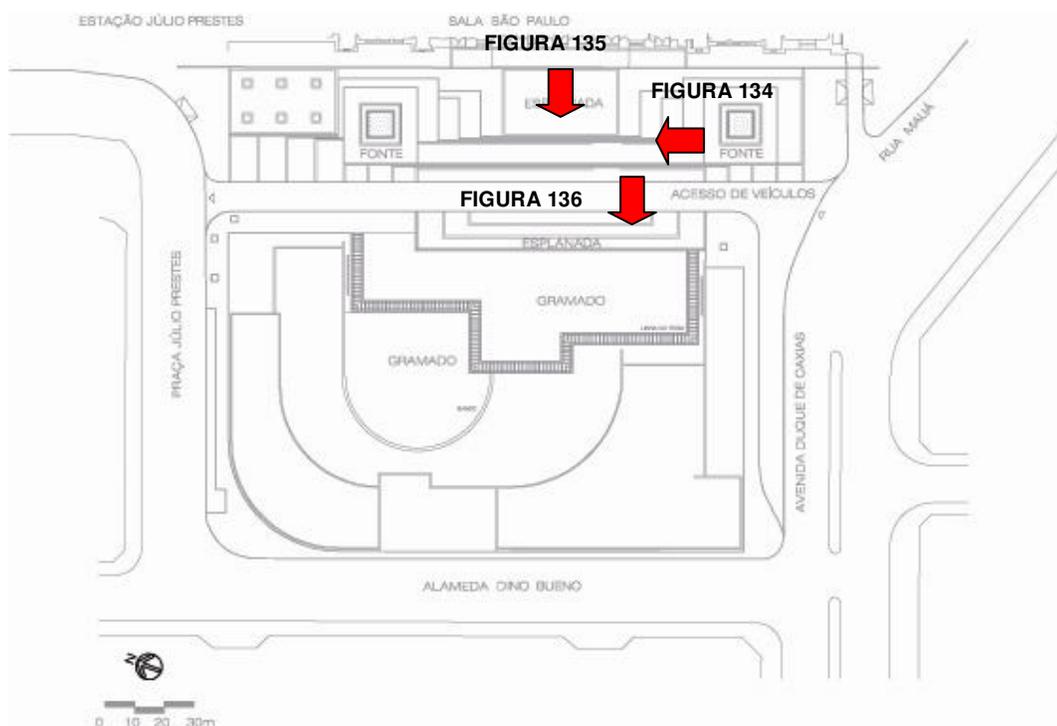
Planta da Praça Júlio Prestes com a indicação das fotos
